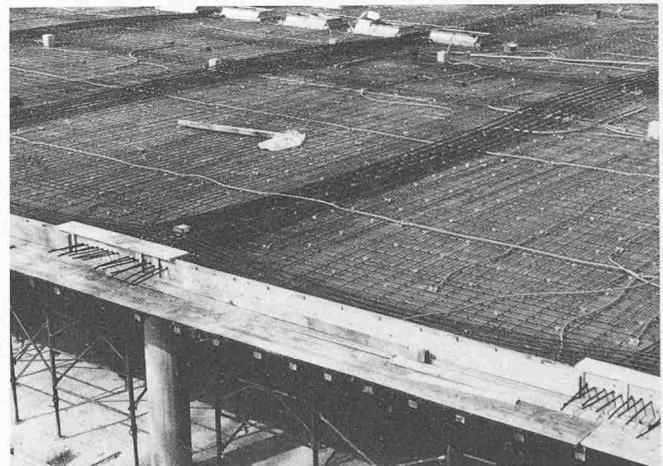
Schulhaus mit Schwimmhalle in Aadorf
